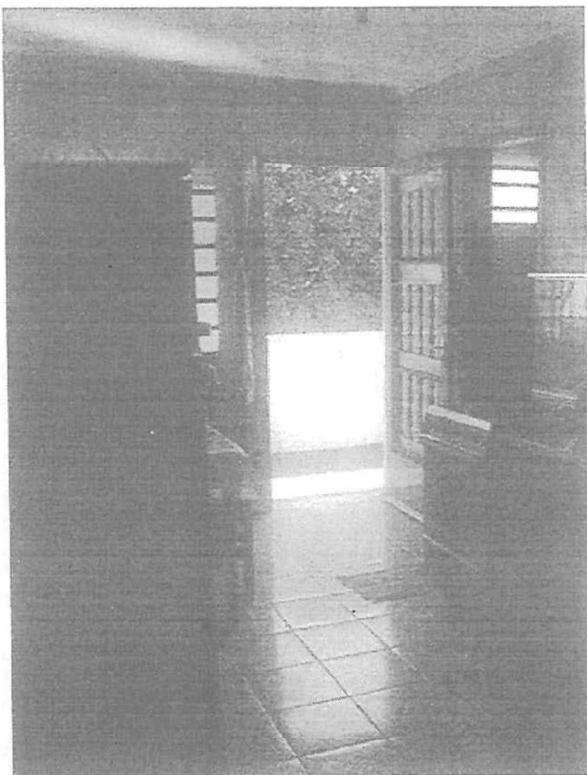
Aspecto da sala existente no pavimento superior.
